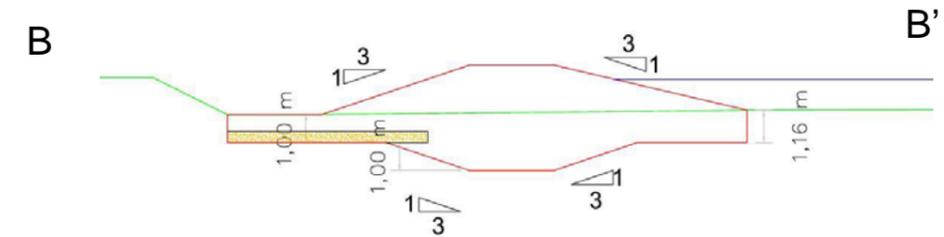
Coupe schématique du principe d'ancrage de l'ouvrage Aval (coupe BB')
